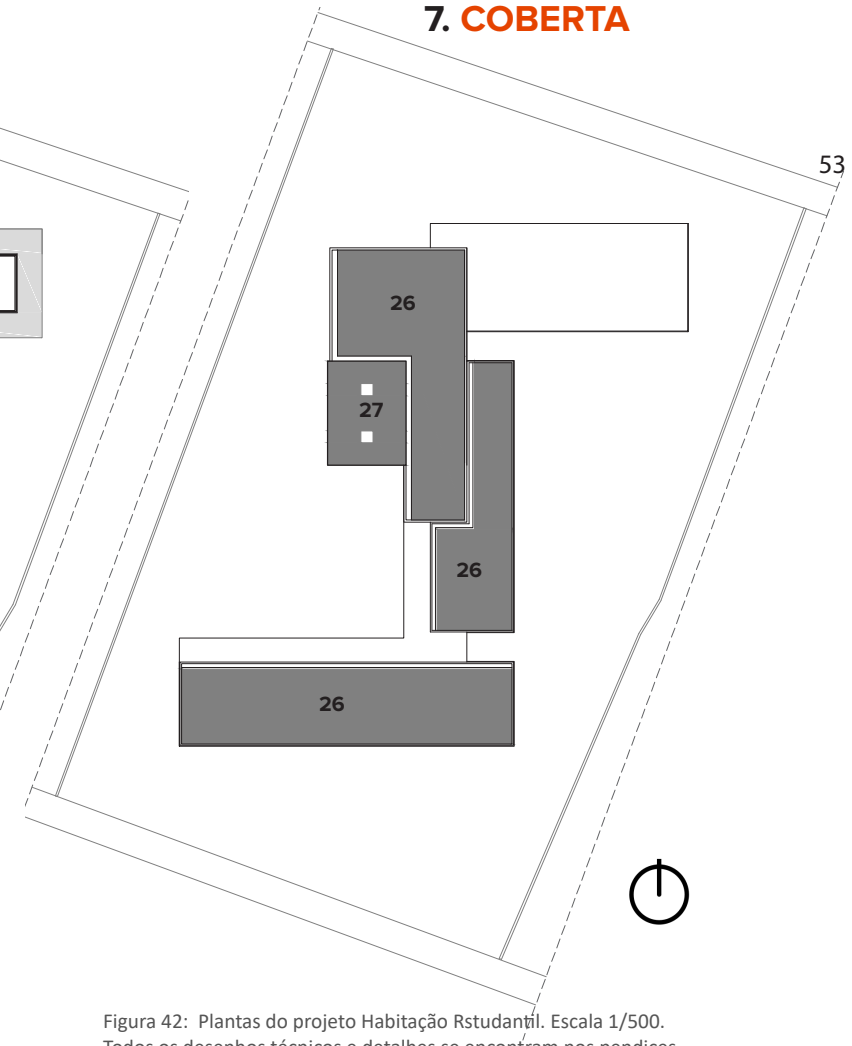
Plantas do projeto Habitação Rstudentil. Escala 1/500.
